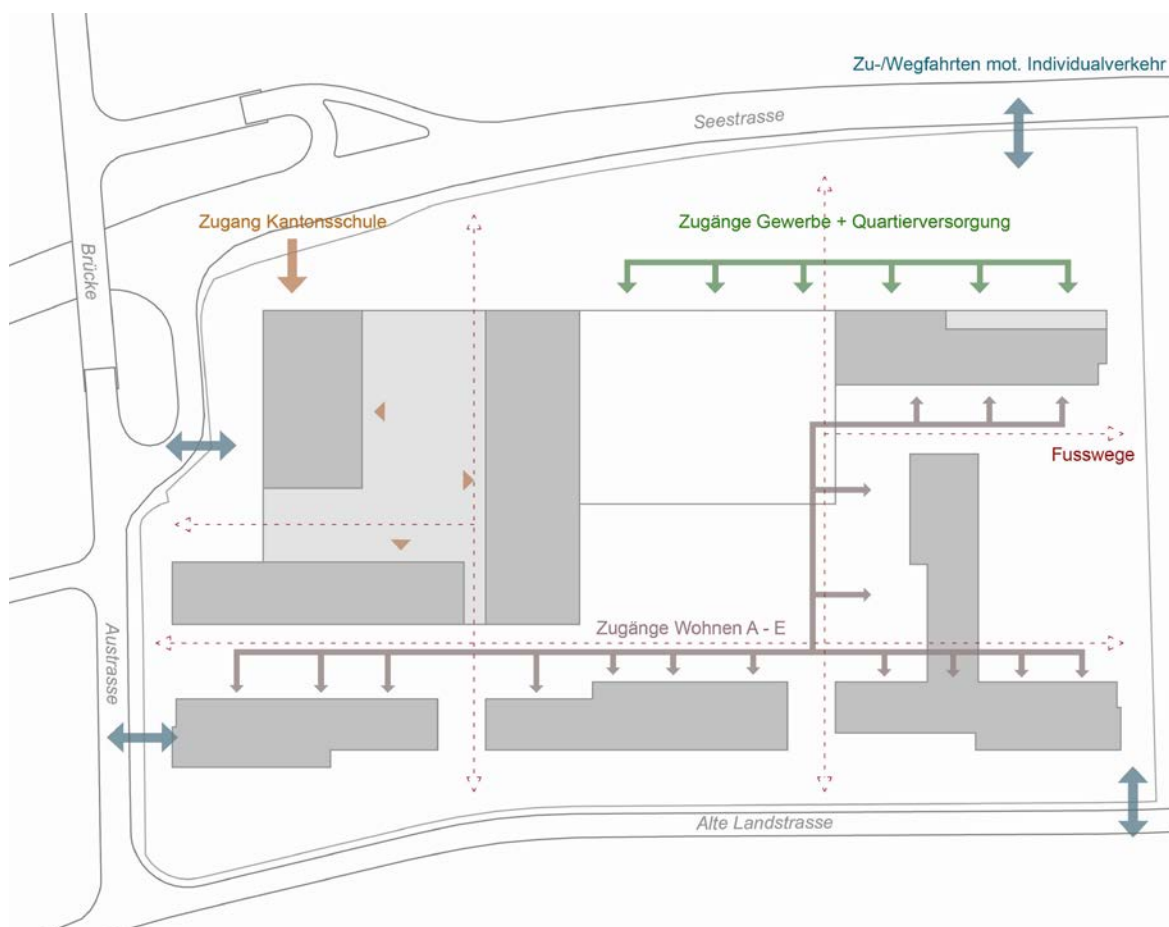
Schema zu Arealzufahrten (hellblaue Pfeile), Erschliessungssystem und Adressierung der Gebäude
